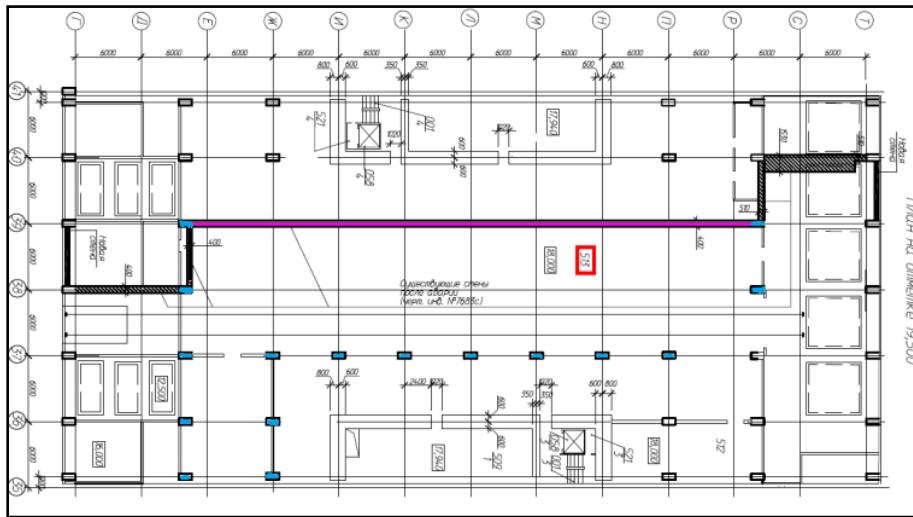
Рассматриваемое помещение блока В в плане на определенной отметке (розовым цветом обозначены стены помещения, являющиеся частью ОК; синим – колонны)
